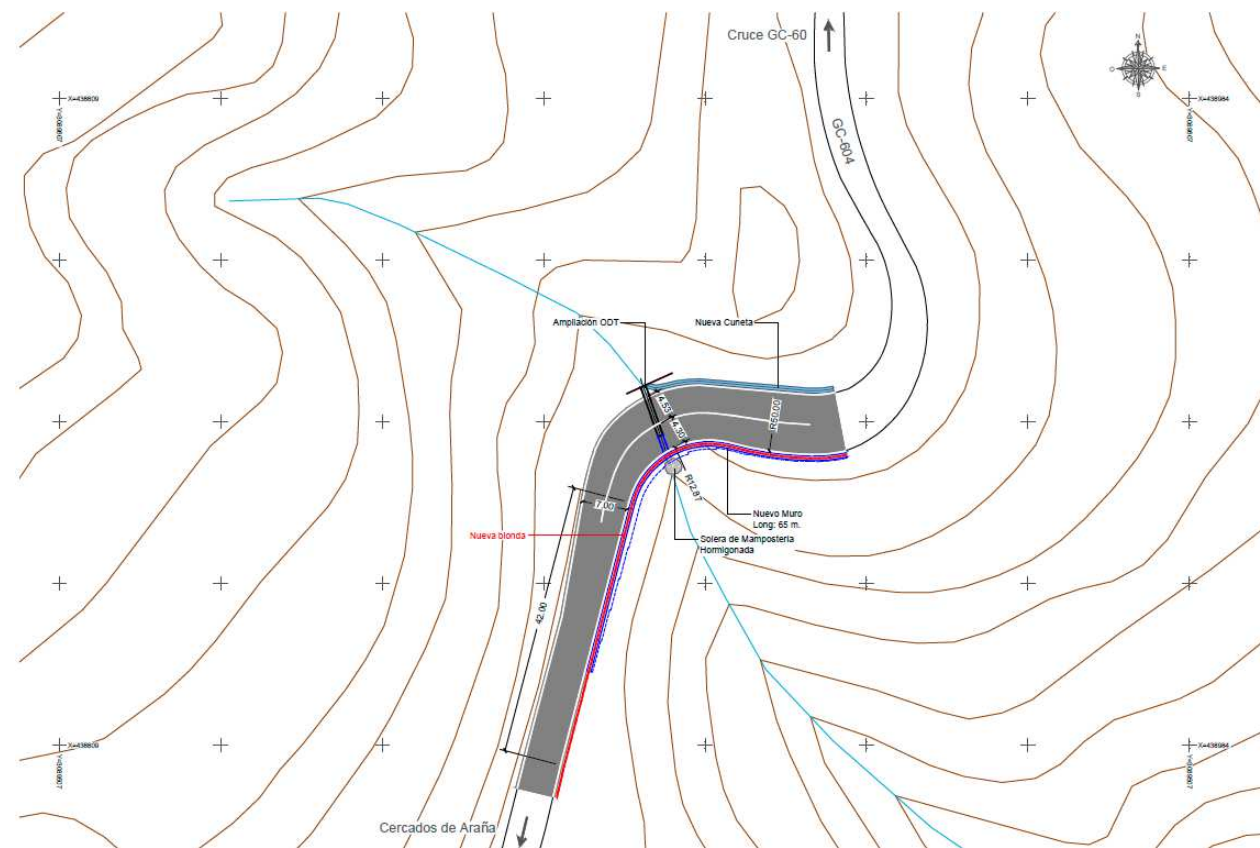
Planta general solución propuesta. Fuente: Elaboración propia.
